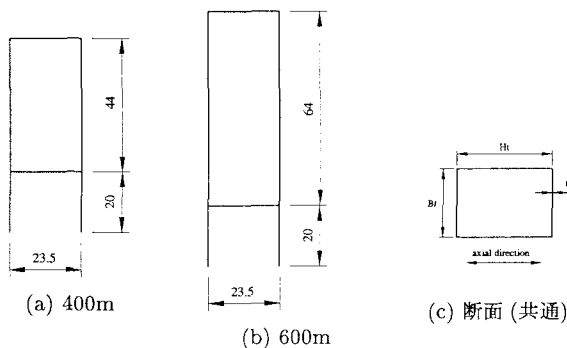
斜張橋および吊橋主塔形状と共通断面 (m)
